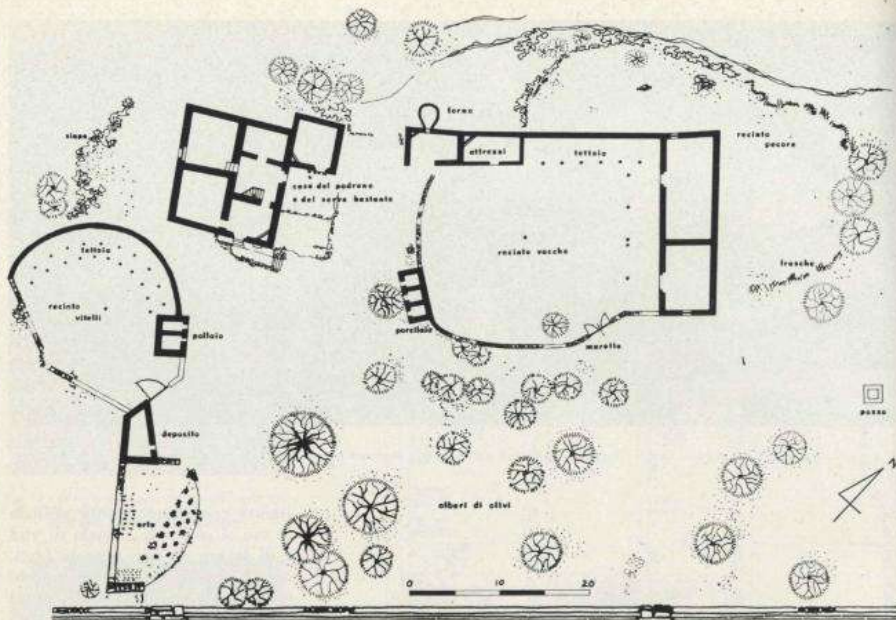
Rilievo del furriadroxiu Chilau (situazione planimetrica).
